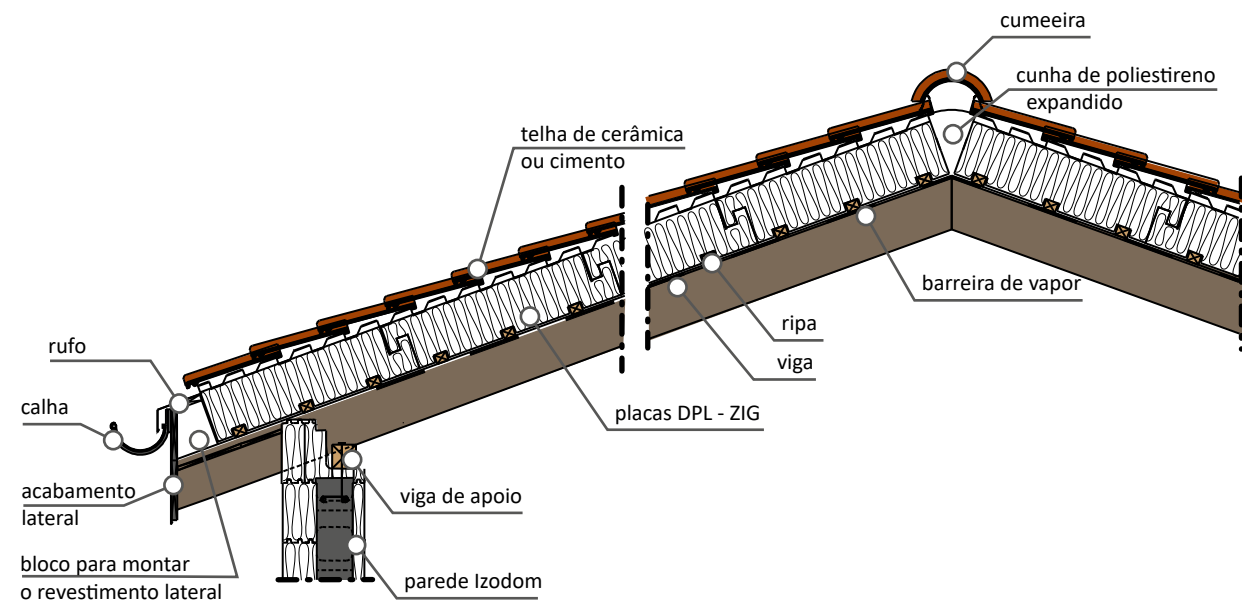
Imagem C. Seção vertical que ilustra um tipo de cobertura de teto com telha plana.
